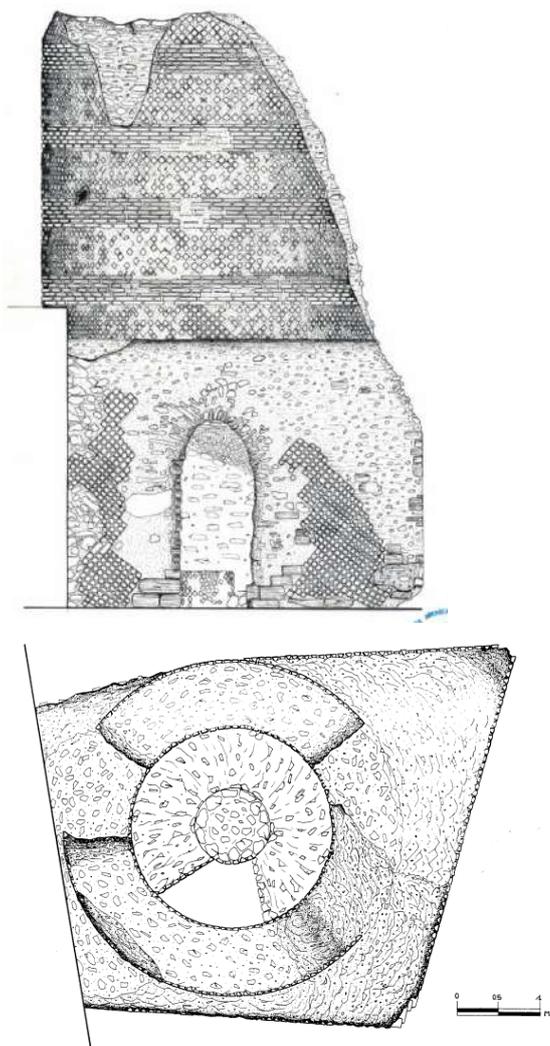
Le Murrelle (318). Prospetto e pianta del mausoleo (RENDINI 2002; Archivio Disegni SBAT 6103/1999)
